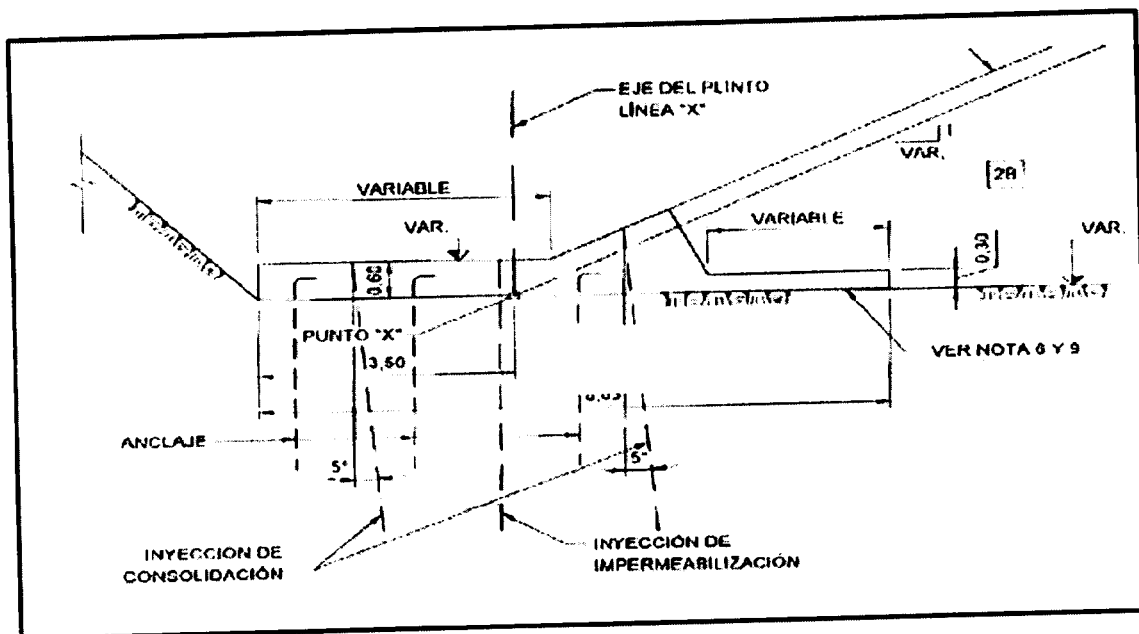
Plinto sobre cimentación Rocosa, estribos (fuera del cauce)
